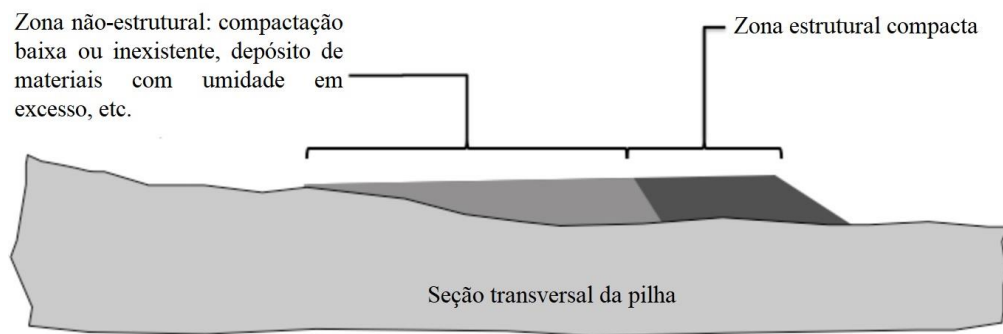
Exemplo de seção de pilha com divisão em duas zonas: estrutural e não-estrutural (Lupo e Hall, 2010)
